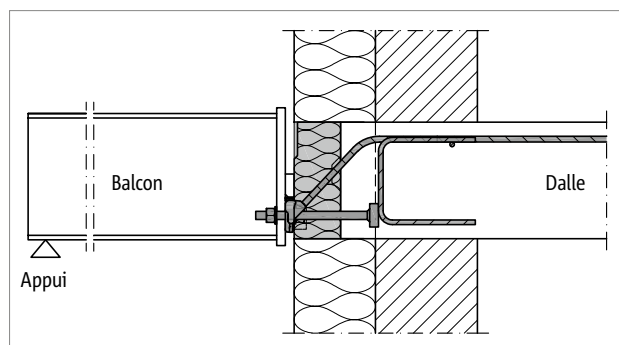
Schöck Isokorb® T type SQ : Le corps isolant affleure le nu extérieur de l'isolation du mur grâce à la saillie de la dalle vers l'extérieur. Ce faisant, les distances aux bords latéraux doivent être respectées
